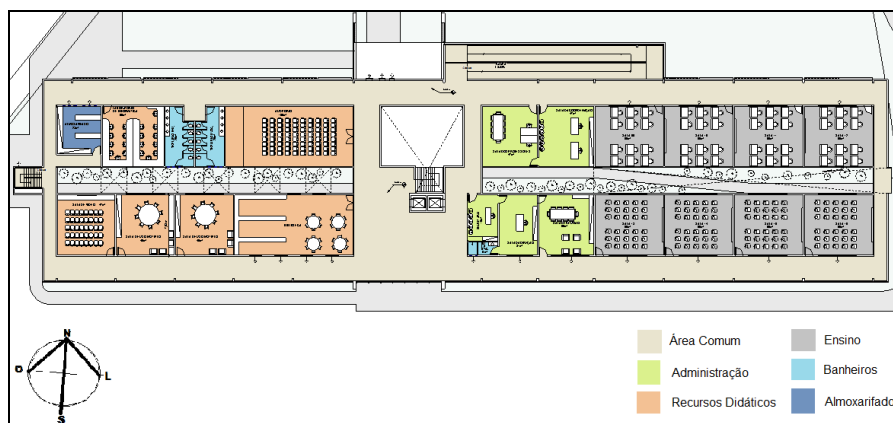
CETCON – Planta Baixa do Pavimento Superior
